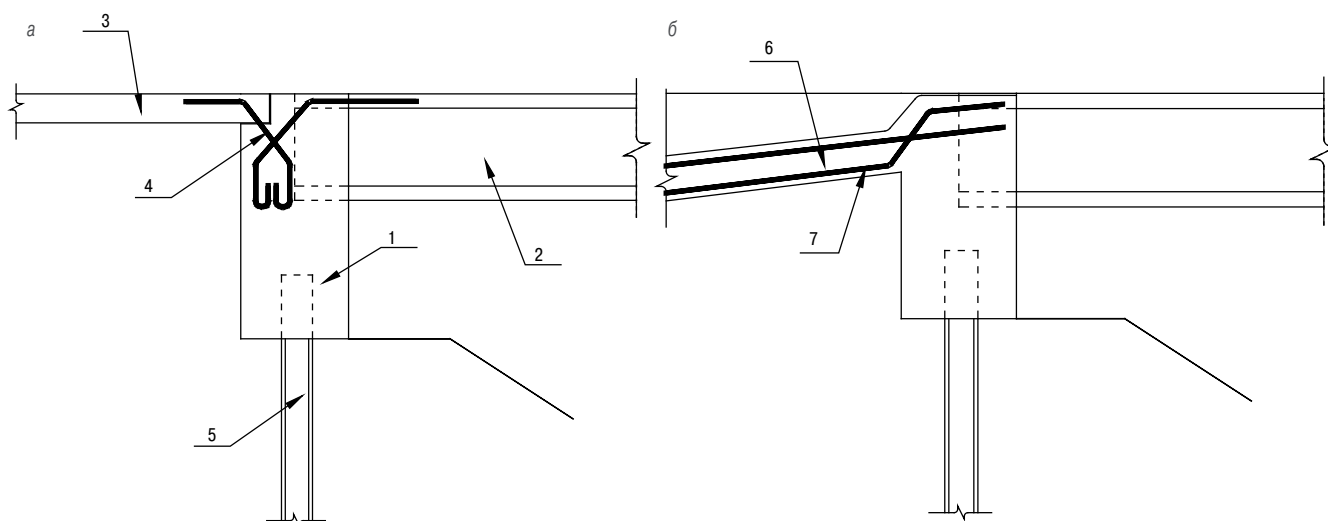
Схемы объединения интегрального устоя с переходной плитой: а – поверхностной; б – заглубленной; 1 – тело устоя; 2 – пролетное строение; 3 – поверхностная переходная плита; 4 – арматурный элемент; 5 – сваи; 6 – заглубленная переходная плита; 7 – арматура плиты
